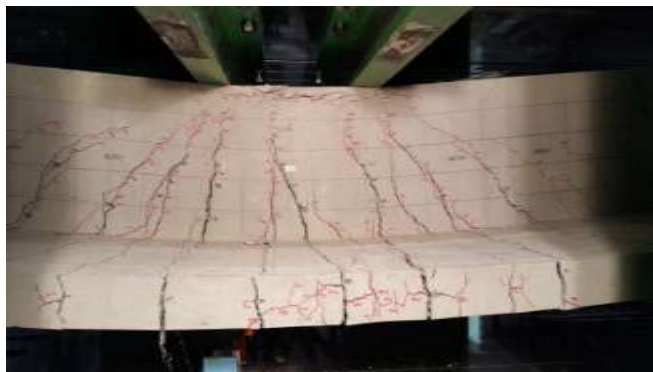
No.2 試験体の最大荷重時ひび割れ性状
